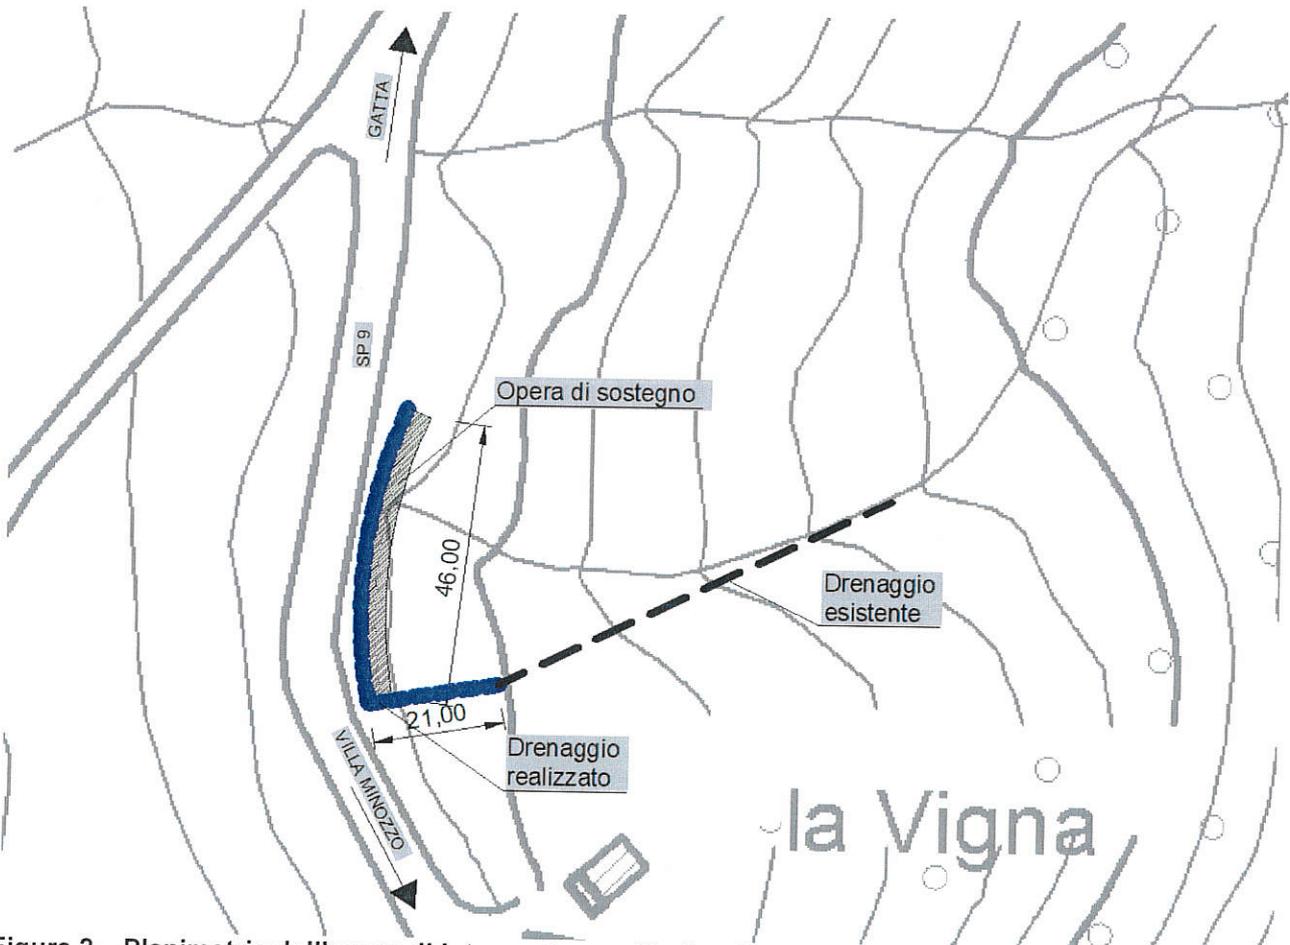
Planimetria dell'opera di intervento con l'indicazione della posizione dei drenaggi.
